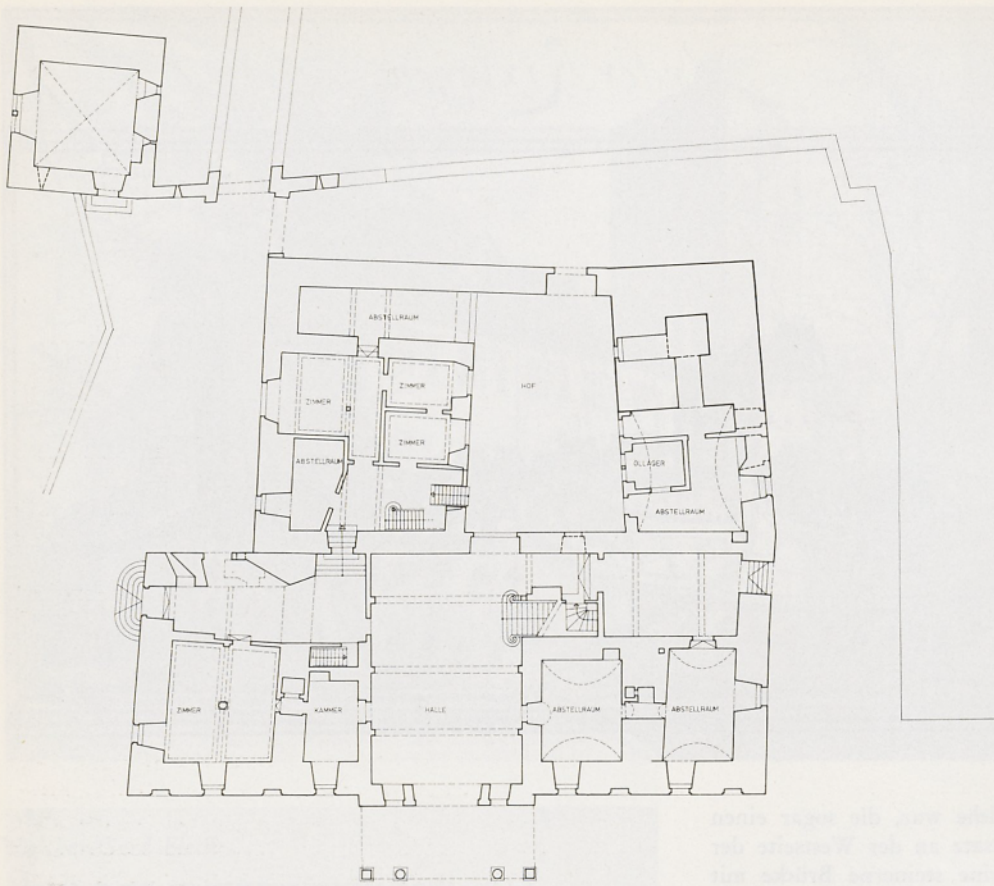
Grundriß des Zustandes im Jahr 1973. Erdgeschoß (Zeichnungen: W.-G. Fleck)
